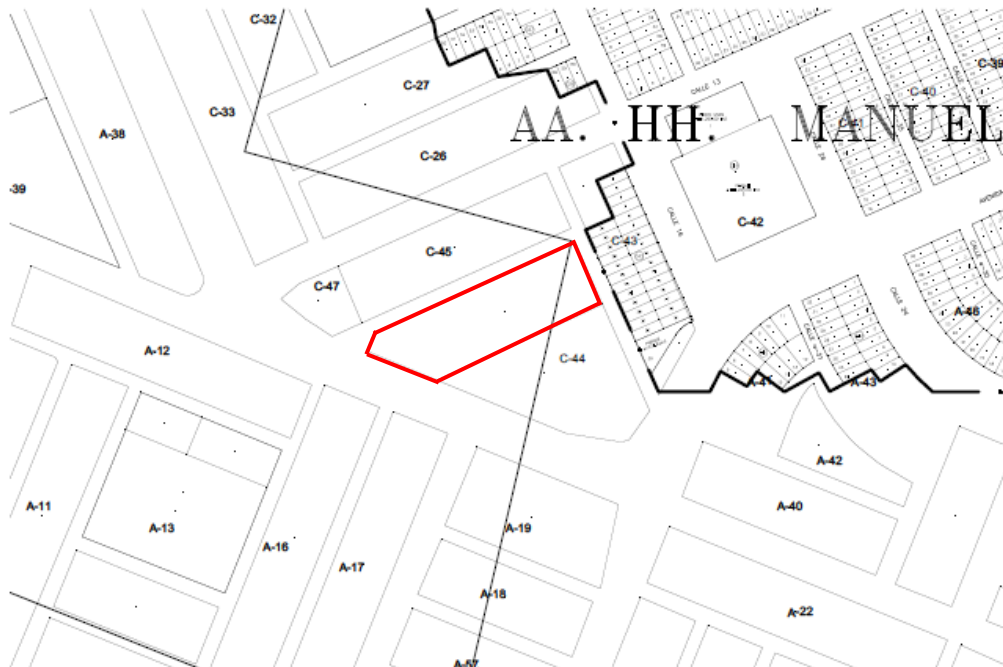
Plano de terreno N° 2. Fuente: Elaboración propia.
